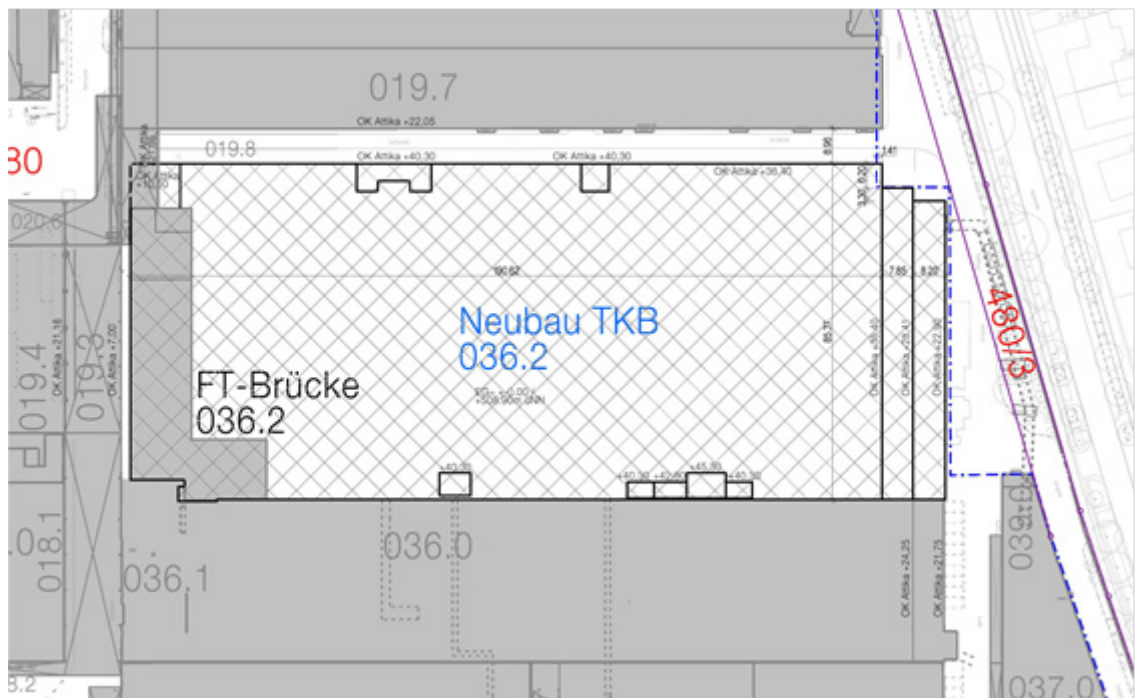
Lageplan Werk 01.10 München, Ausschnitt Gebäude 036.2
